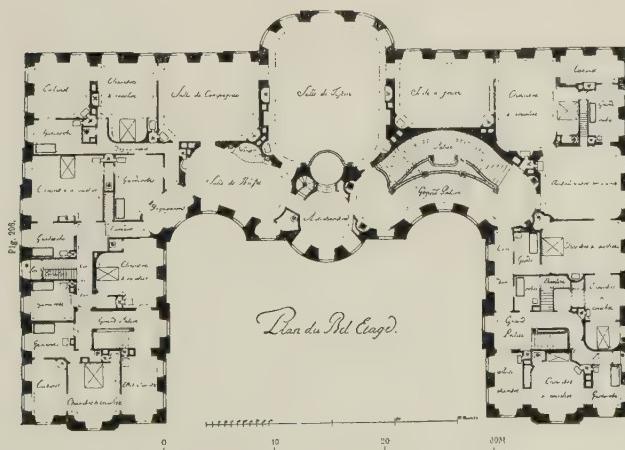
Schloß Thallwitz bei Grimma Grundriß
